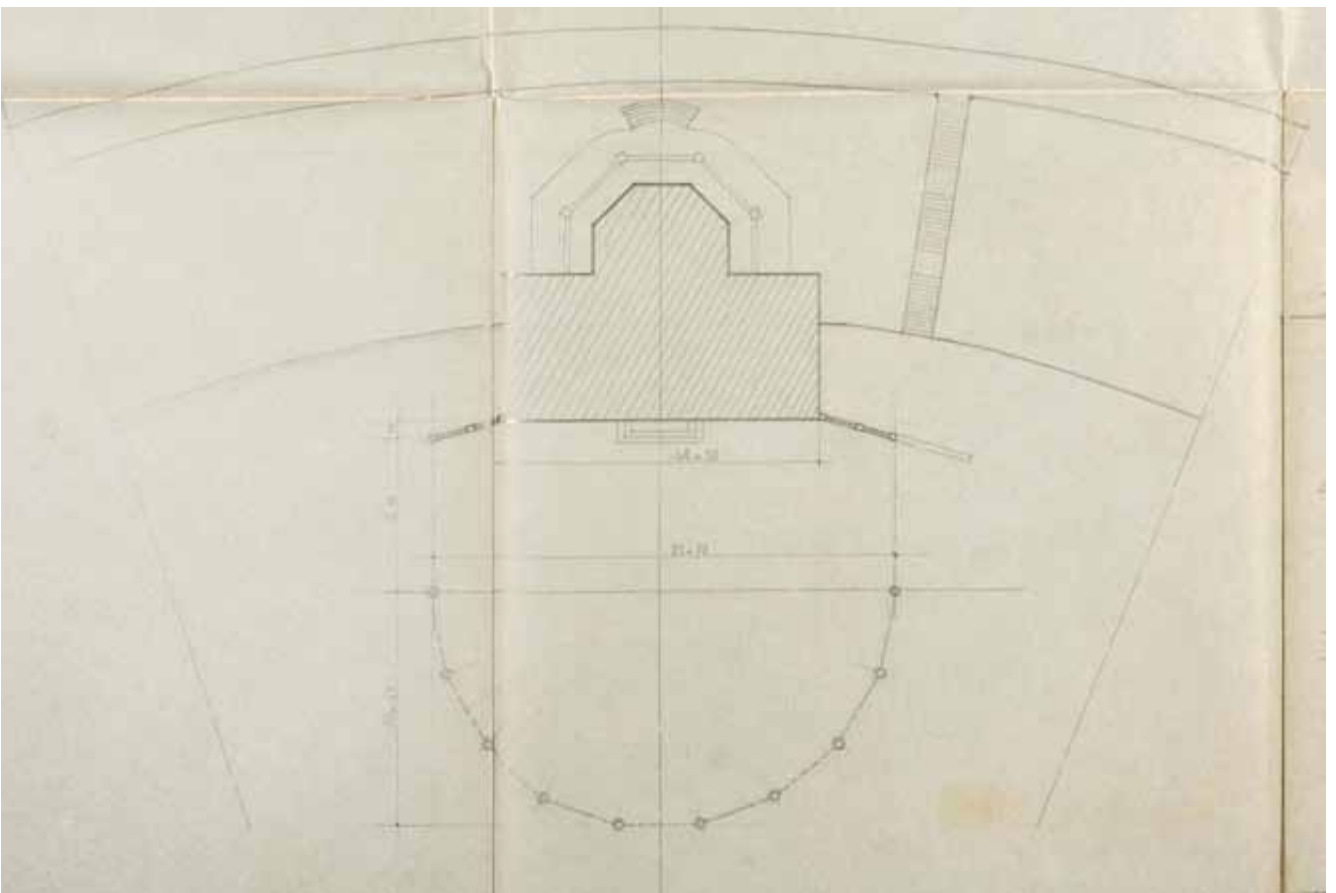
Opmetingsplan van de bestaande toestand door Simon Brigode, september 1963.
